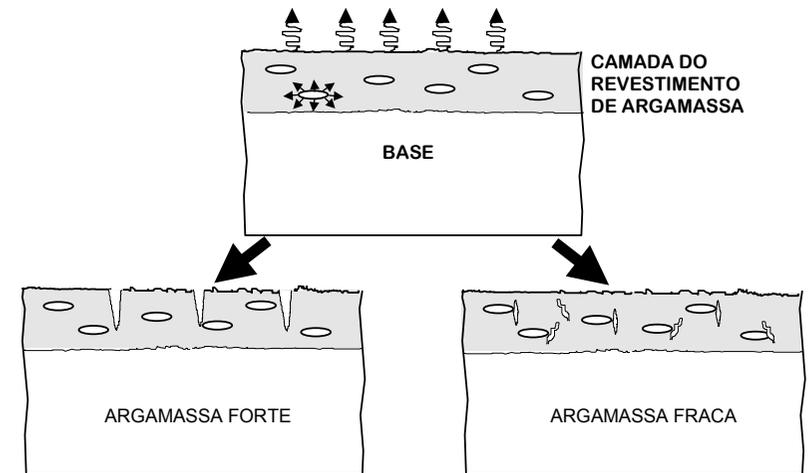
Fissuração da argamassa por retração na secagem: argamassa forte x argamassa fraca
